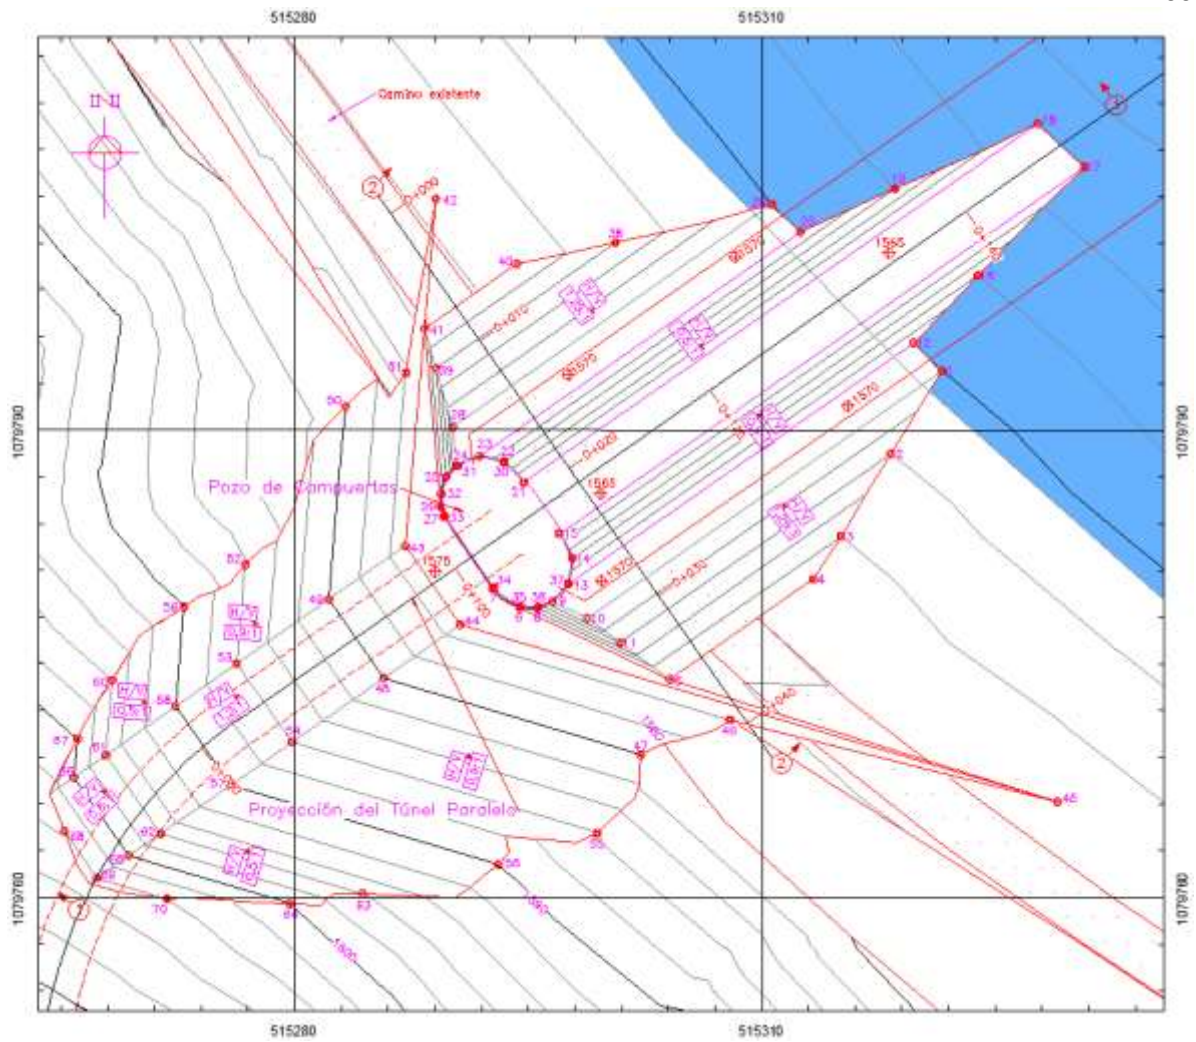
Planta con la propuesta de excavación para la Estructura de Entrega al Embalse
